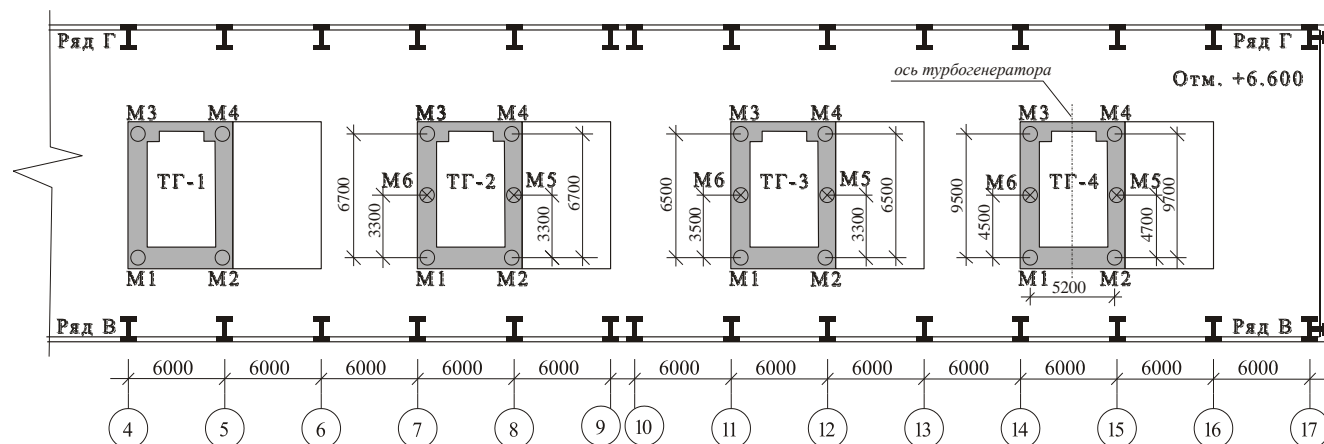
Схема расположения осадочных марок на фундаментах ТГ1...ТГ4
